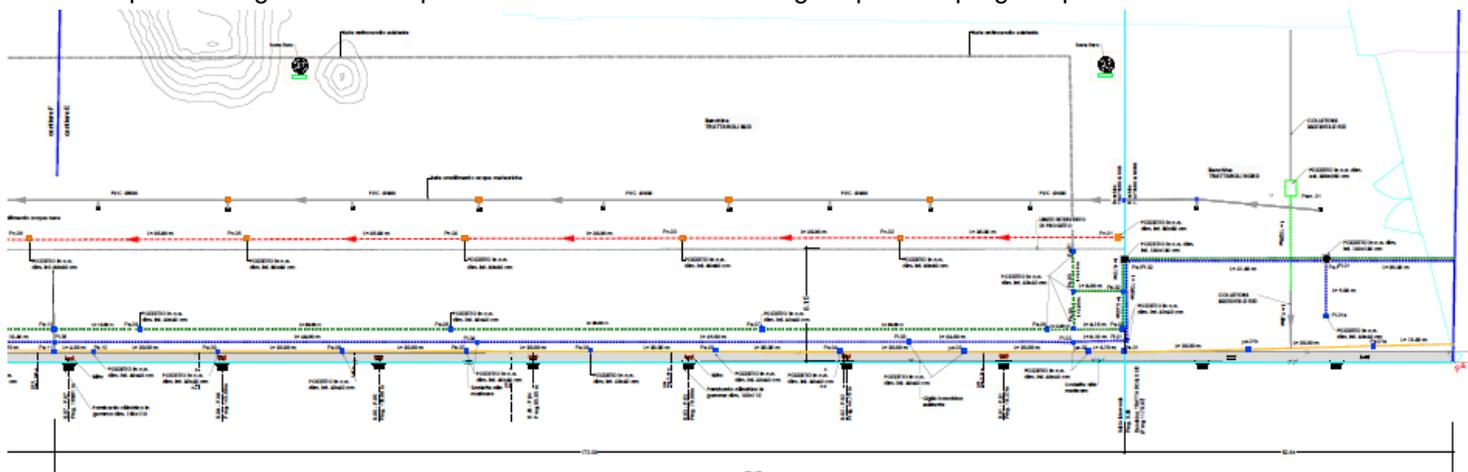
Planimetria impianti di progetto – Cantiere E + D2
